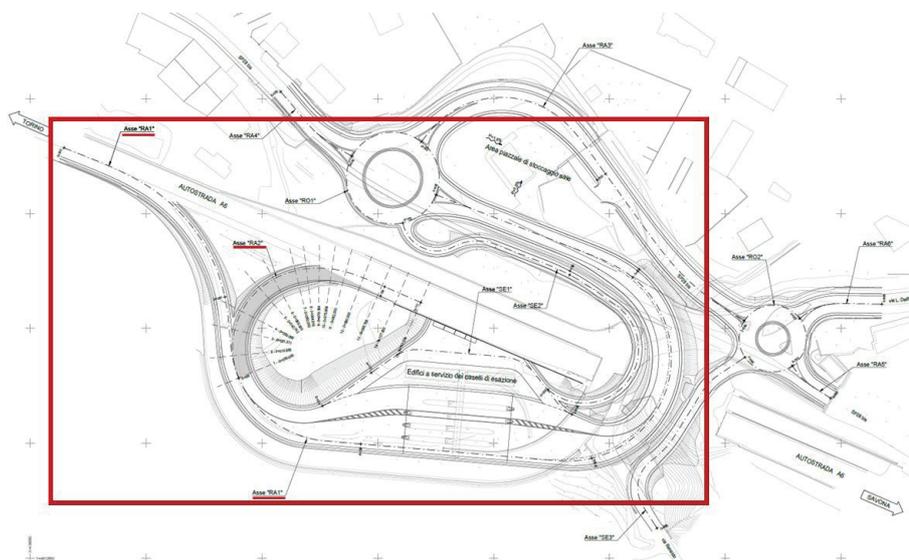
Planimetria generale ASSE RA1 e RA2
